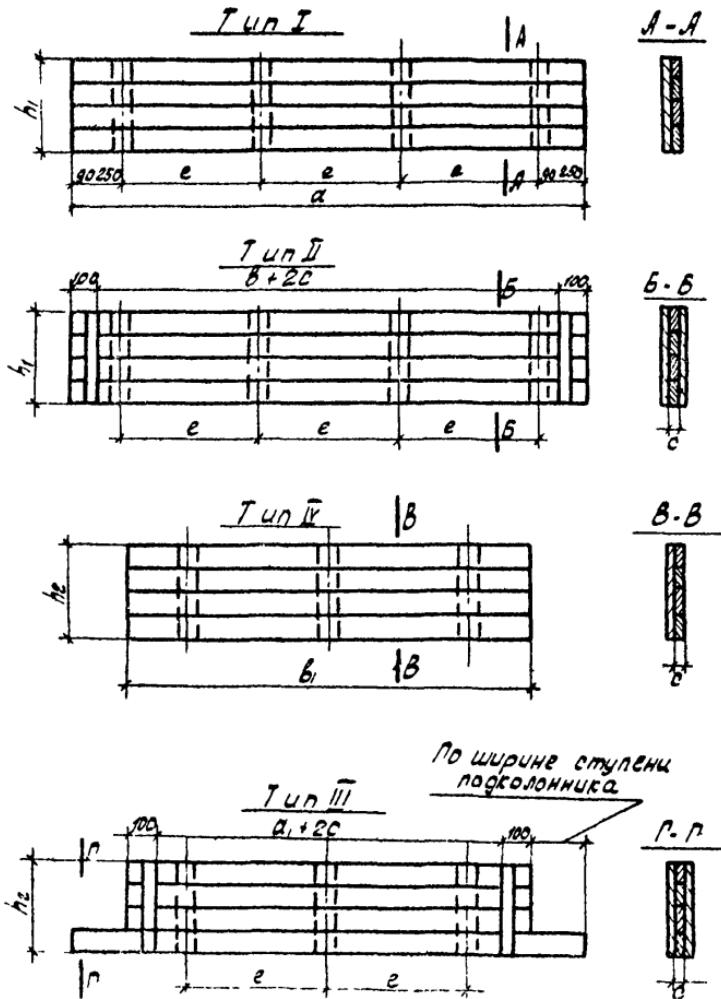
Типы цоколей опалубки ступенчатого фундамента:
